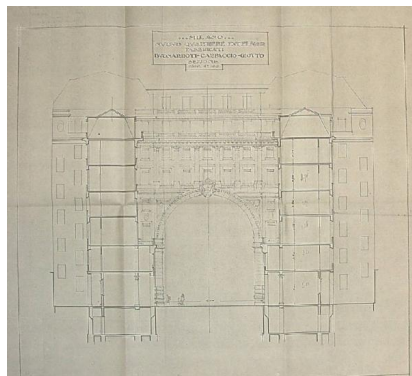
Prospetto e sezione su via Salvini (Archivio Civico Milano, Edilizia Privata)
